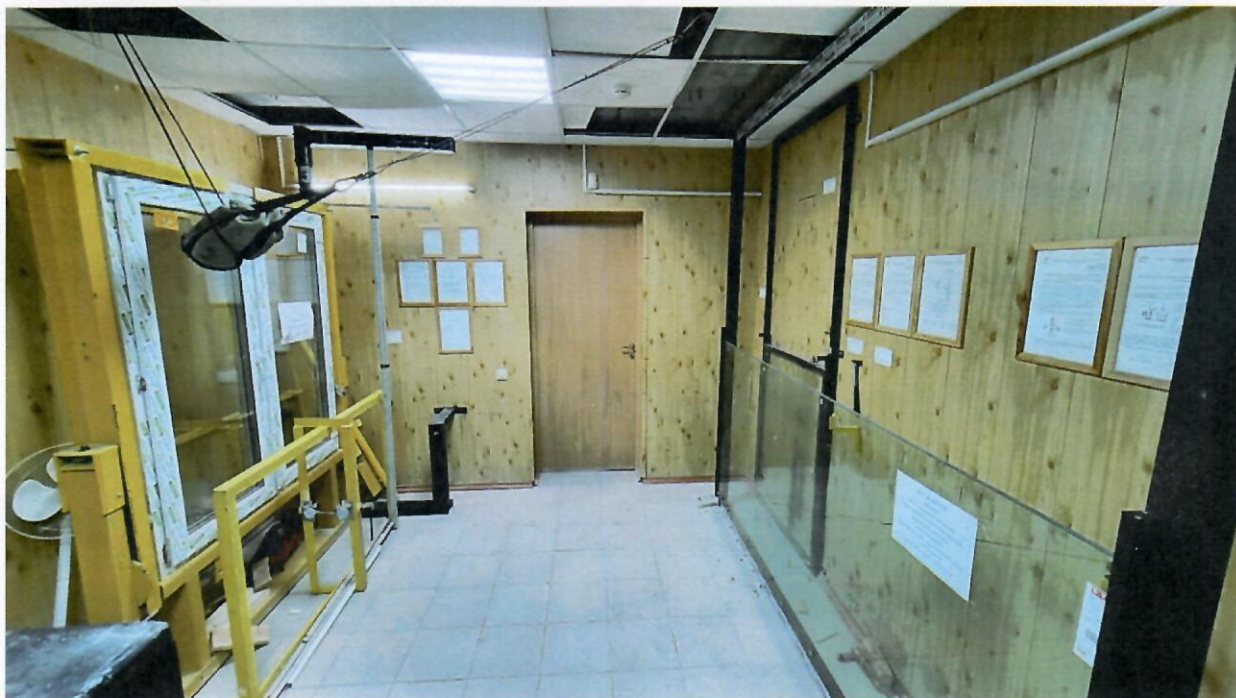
Общий вид стенда для испытаний ограждающей светопрозрачной конструкции системы французских балконов «KRAUSS KRR» с ограждающим экраном из многослойного стекла толщиной 17,52мм (8+1,52+8) к динамической нагрузке (удар мягким неупругим телом массой 30кг, высота падения мешка 1200 мм).
